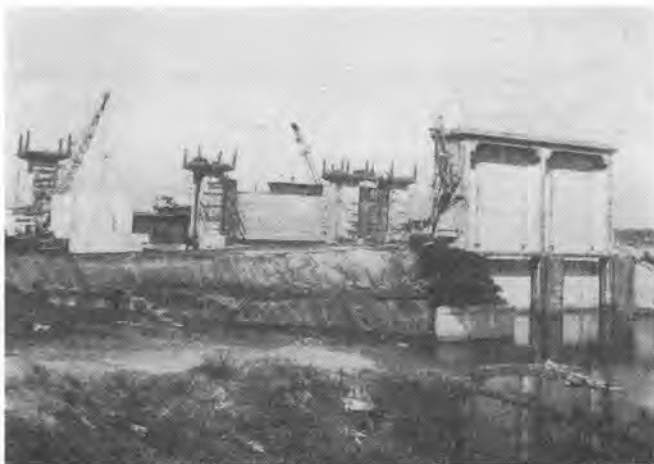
施工中の黒部川水門（手前が撤去する旧水門）
